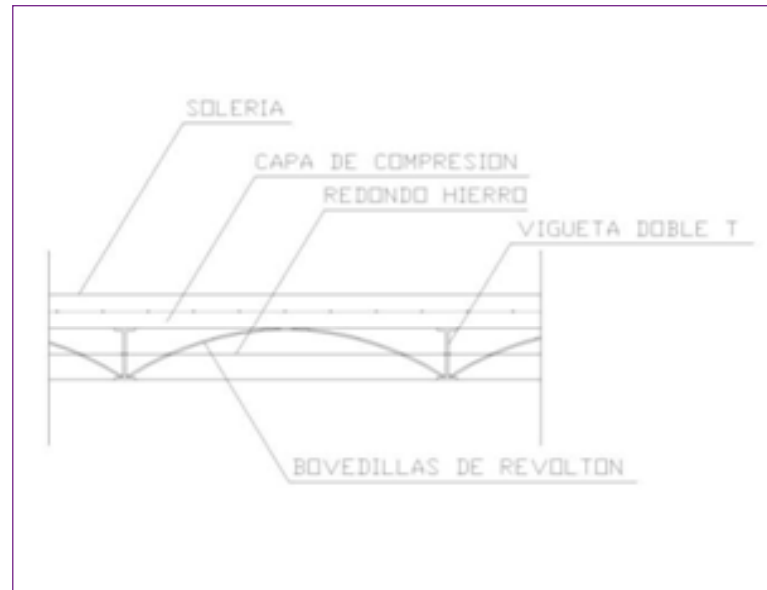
Fig II. Detalle constructivo de forjado compuesto por vigas de hierro y revolton cerámico
